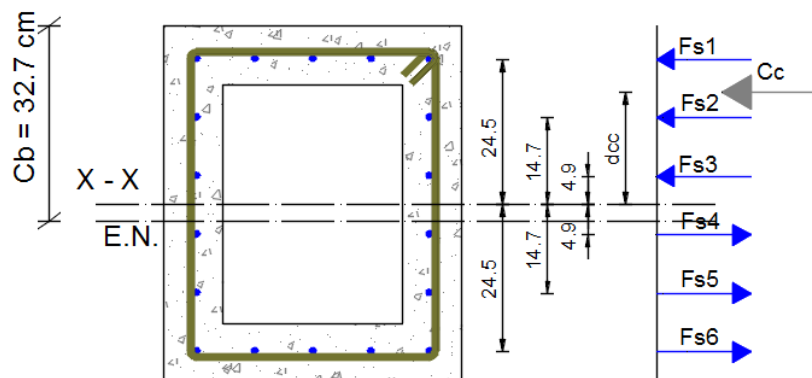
Esquema general de deformaciones, esfuerzos y fuerzas en la sección transversal rectangular
